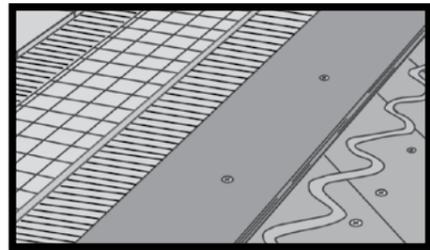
Este sistema se compone de paneles a base de cemento contenidos entre dos redes de fibra de vidrio, para colocar en pared o en piso fijados a una superestructura de manera mecánica o química. Para la realización de este fondo hay que seguir las indicaciones del fabricante y prestar atención para que los puntos de contacto entre las placas estén bien llenos de adhesivo y tengan superpuesta una banda de red de fibra de vidrio hundida en el adhesivo de colocación. Esto sirve para asegurarse de que el fondo no presente grietas.
